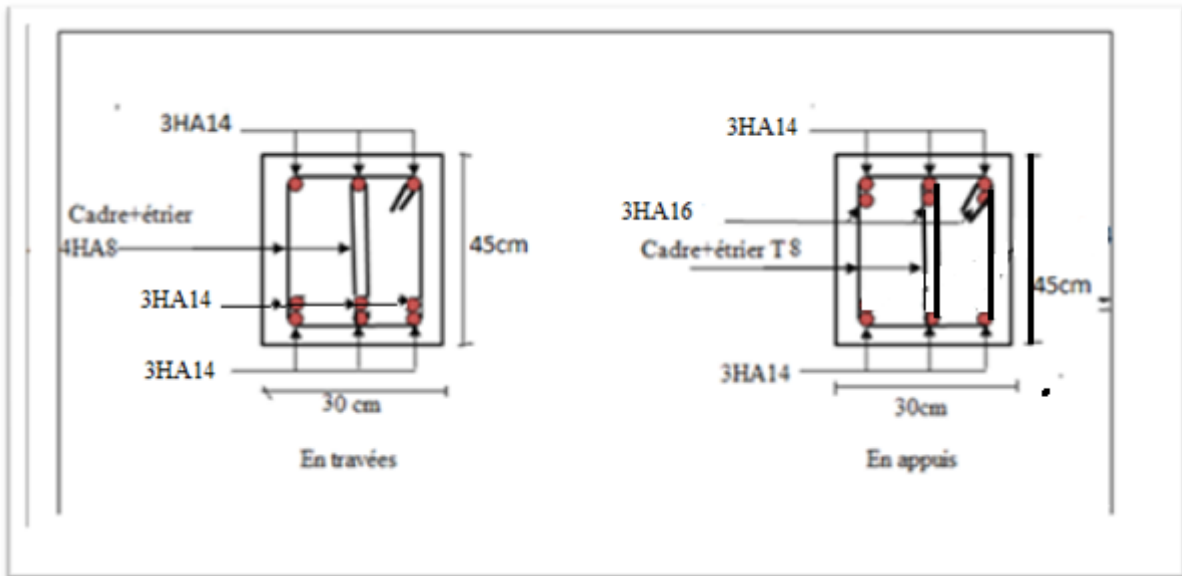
schéma de ferrailage poutres secondaires étage 01 aux 8^{ème}
